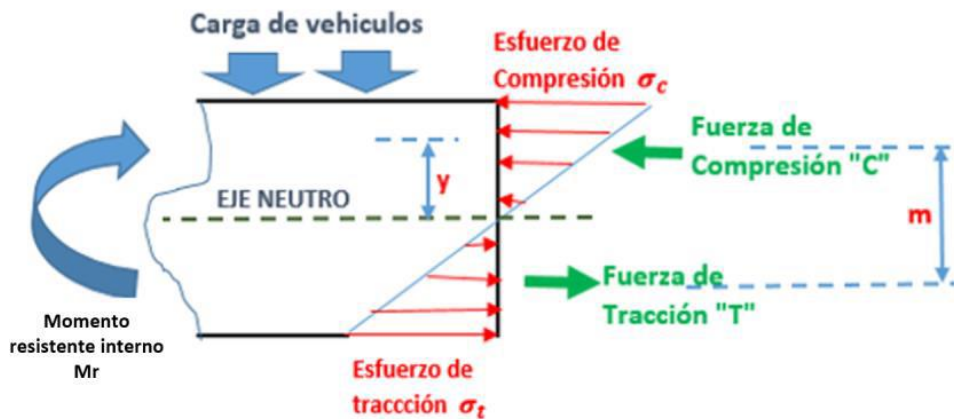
Modelo estructural simplificado de un pavimento rígido
